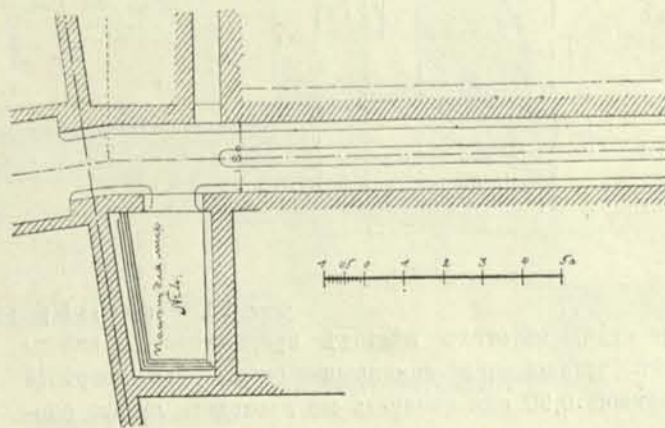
Деталь жѣлѣзобетоннаго покрытія.
